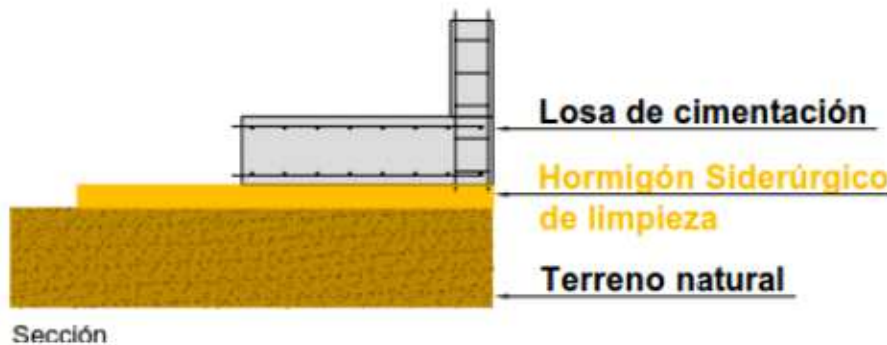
Hormigón de limpieza bajo zapata [18]
